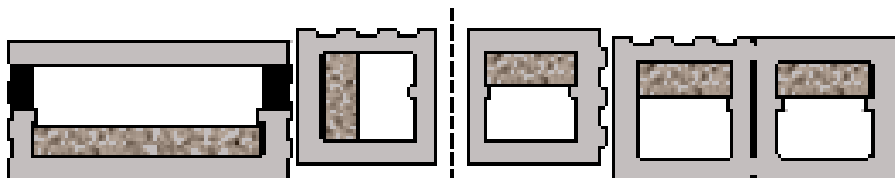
Blocos de encaixe da FASWALL (Fonte: <http://www.faswall.com>)
